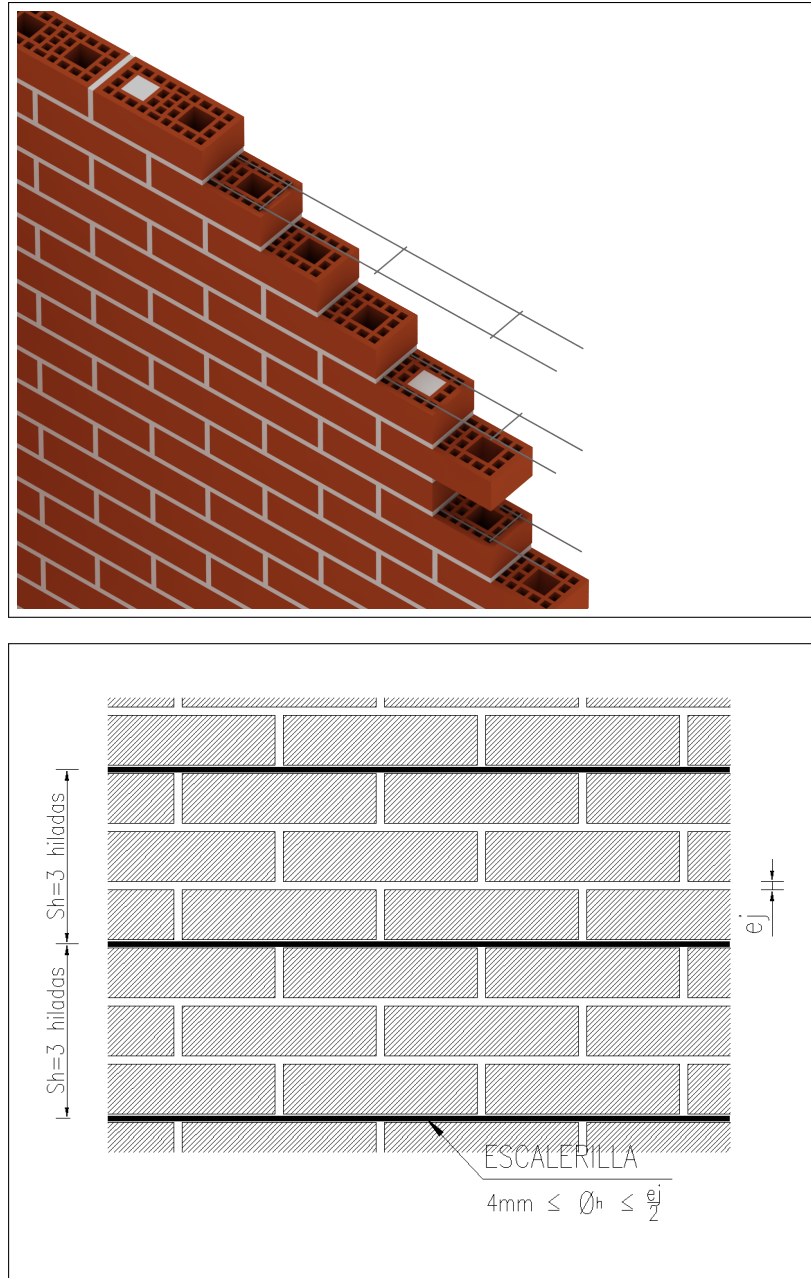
Distribución de las barras de refuerzo horizontal (escalerillas) a lo alto de un paño de albañilería
